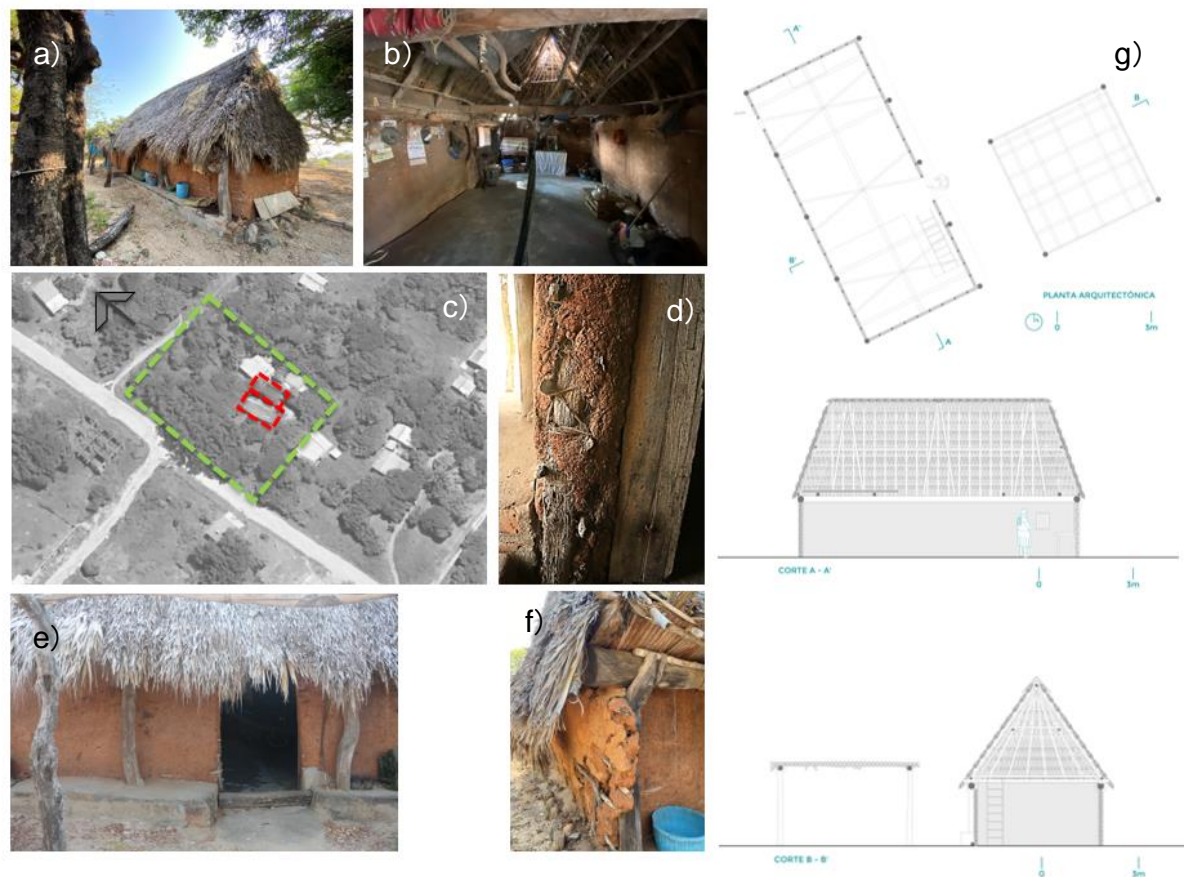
Ficha de integración de información gráfica sobre el sistema de bajareque de San Francisco Pueblo Viejo. a) vista exterior fachada norte y oriente, b) vista interior, c) relación del solar con la construcción de bajareque, d) detalle de amarre de pencas de palma en tresbolillo, e) vista del acceso fachada oriente f) detalle de unión de estructura portante y bajareque y g) planta y sección arquitectónica (acervo del LABPYSCT: fotografías y dibujo por Paul Castillo)
